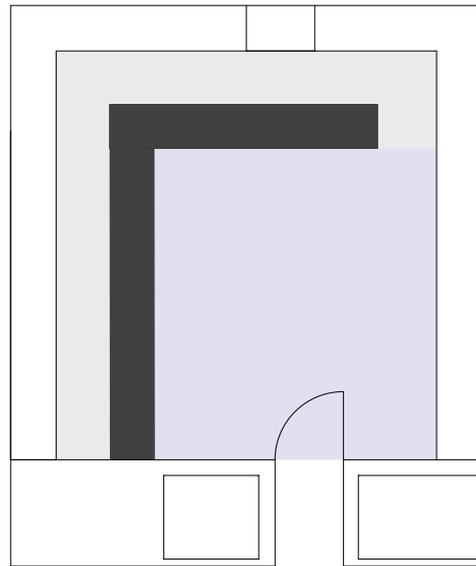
Grundriss Verkaufsraum Knöpfe Ahammer
